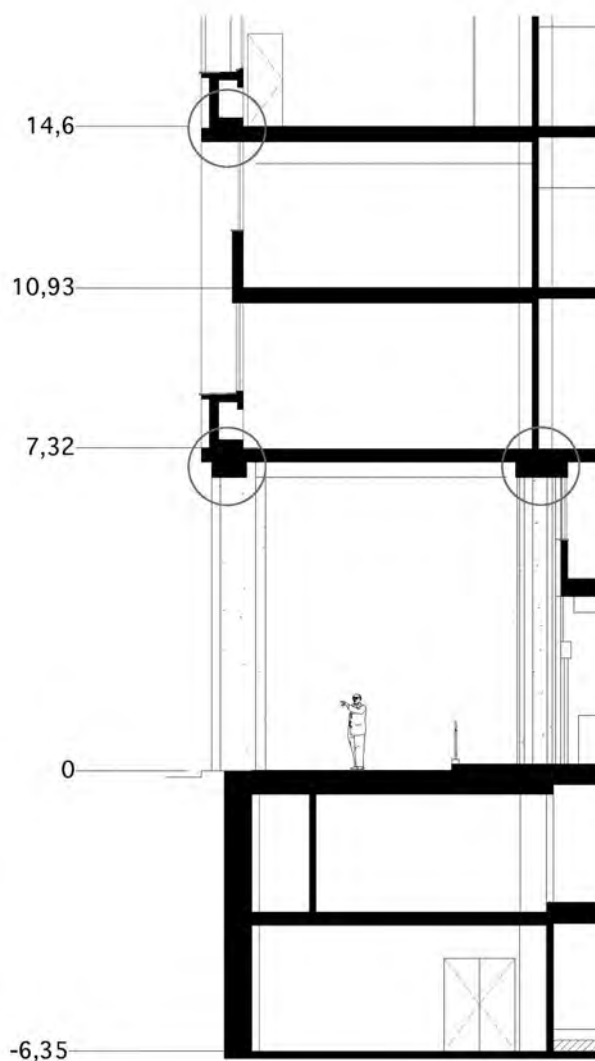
Detalhe do corte transversal, com as altura parciais e indicação das vigas horizontais de reforço das lajes.
